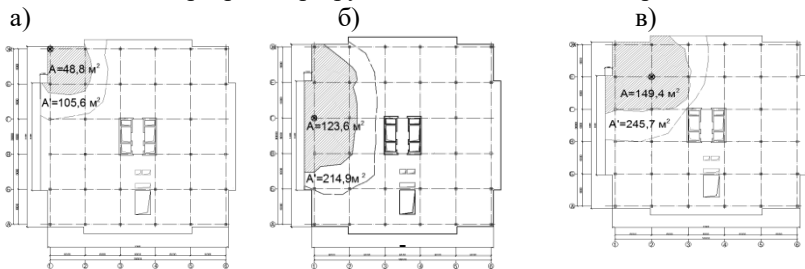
Схема разрушение плиты перекрытия первого этажа: а) удаление колонны Ж/1; б) удаление колонны Г/1; в) удаление колонны Е/2
